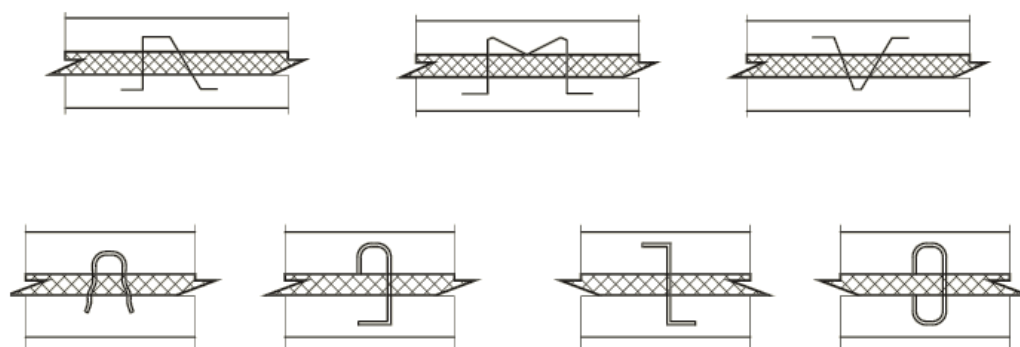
Exemplos de conetores metálicos aplicados em painéis sandwich em betão, adaptado de [17]
